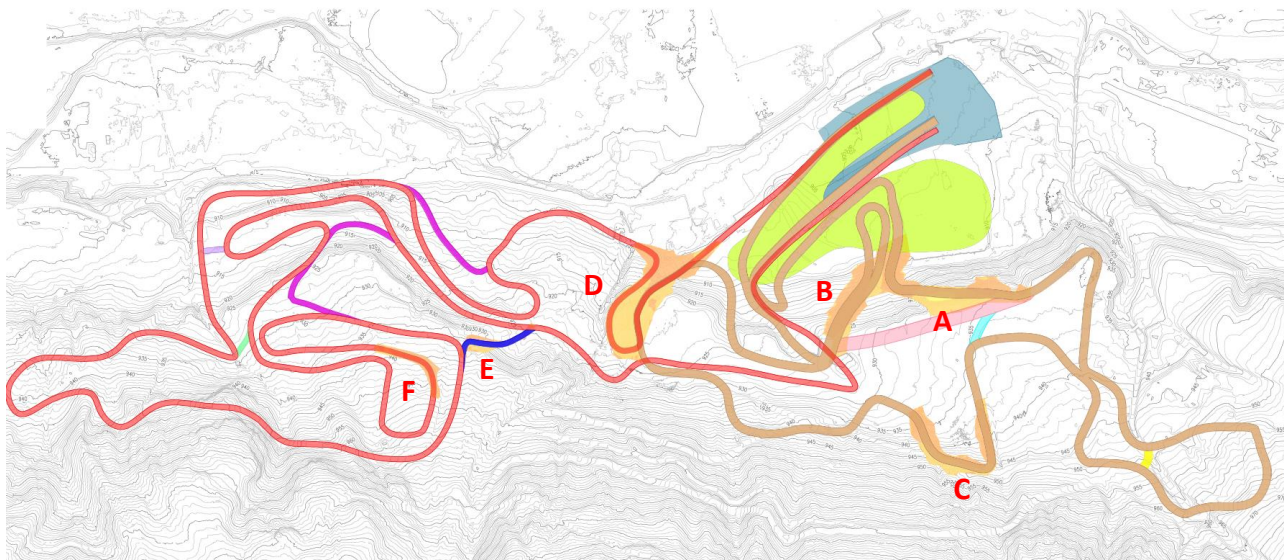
Planimetria sterri e riporto con indicazione zone di intervento - scala a vista
